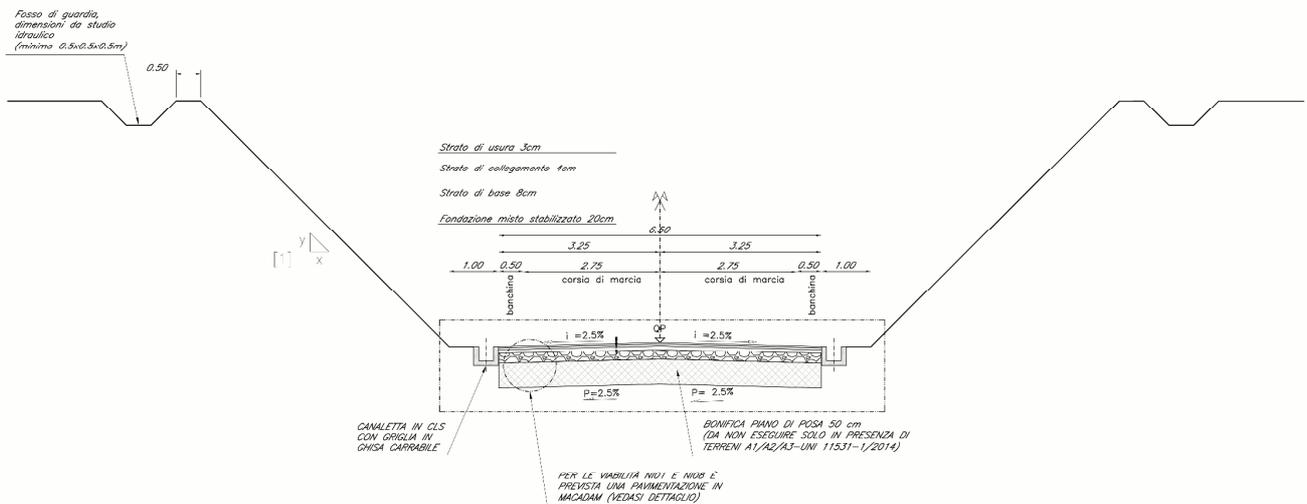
SEZIONE TIPO IN TRINCEA.
